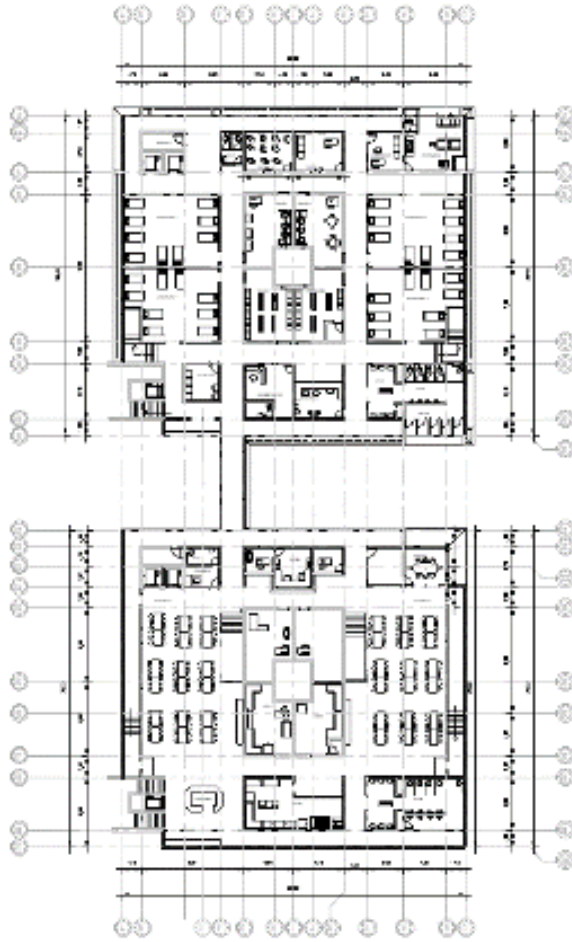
Figura 199 Planta arquitectónica n3, eh, n2, em.
